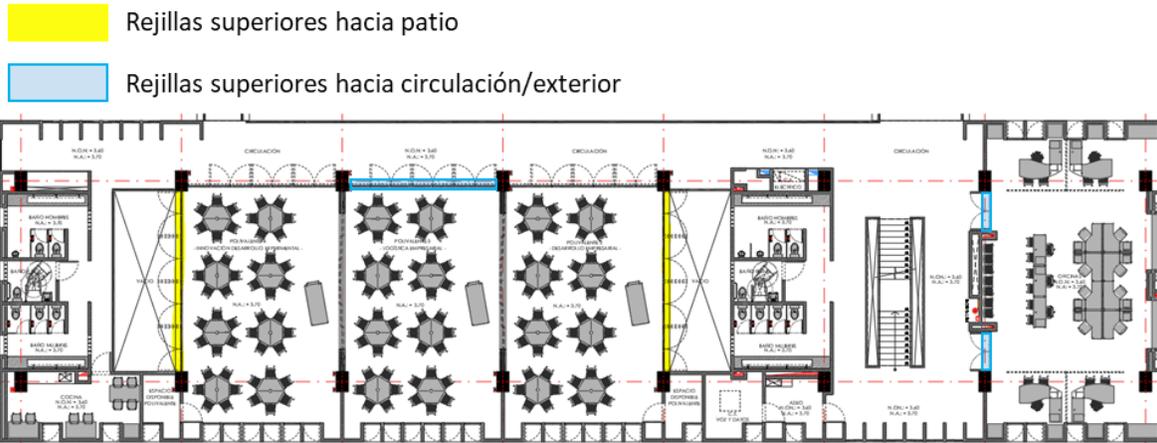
Ubicación propuesta de rejillas superiores en fachadas interiores de las salas.
